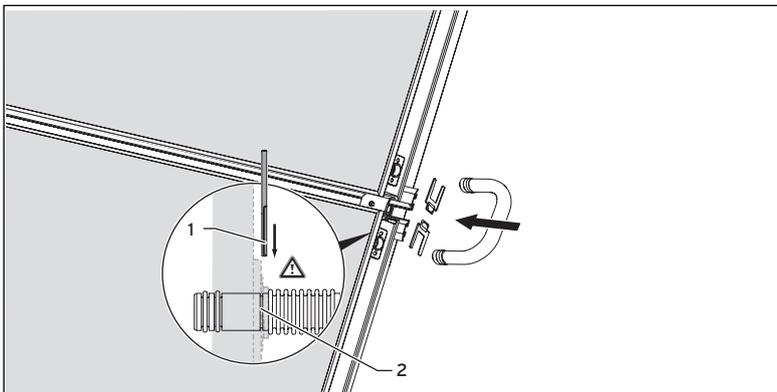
Collegamento dei collettori VFK 150 H disposizione sovrapposta del campo
